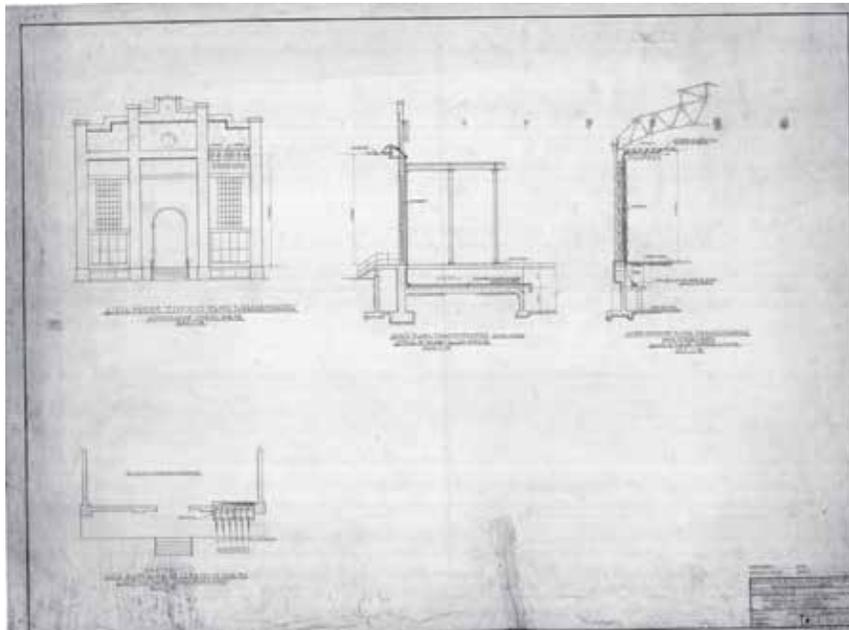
Plano A-2242 "Detalles de Llegada y entrada de cables al edificio. Planta Turbogeneradores", 8 de abril de 1961. AHF.
